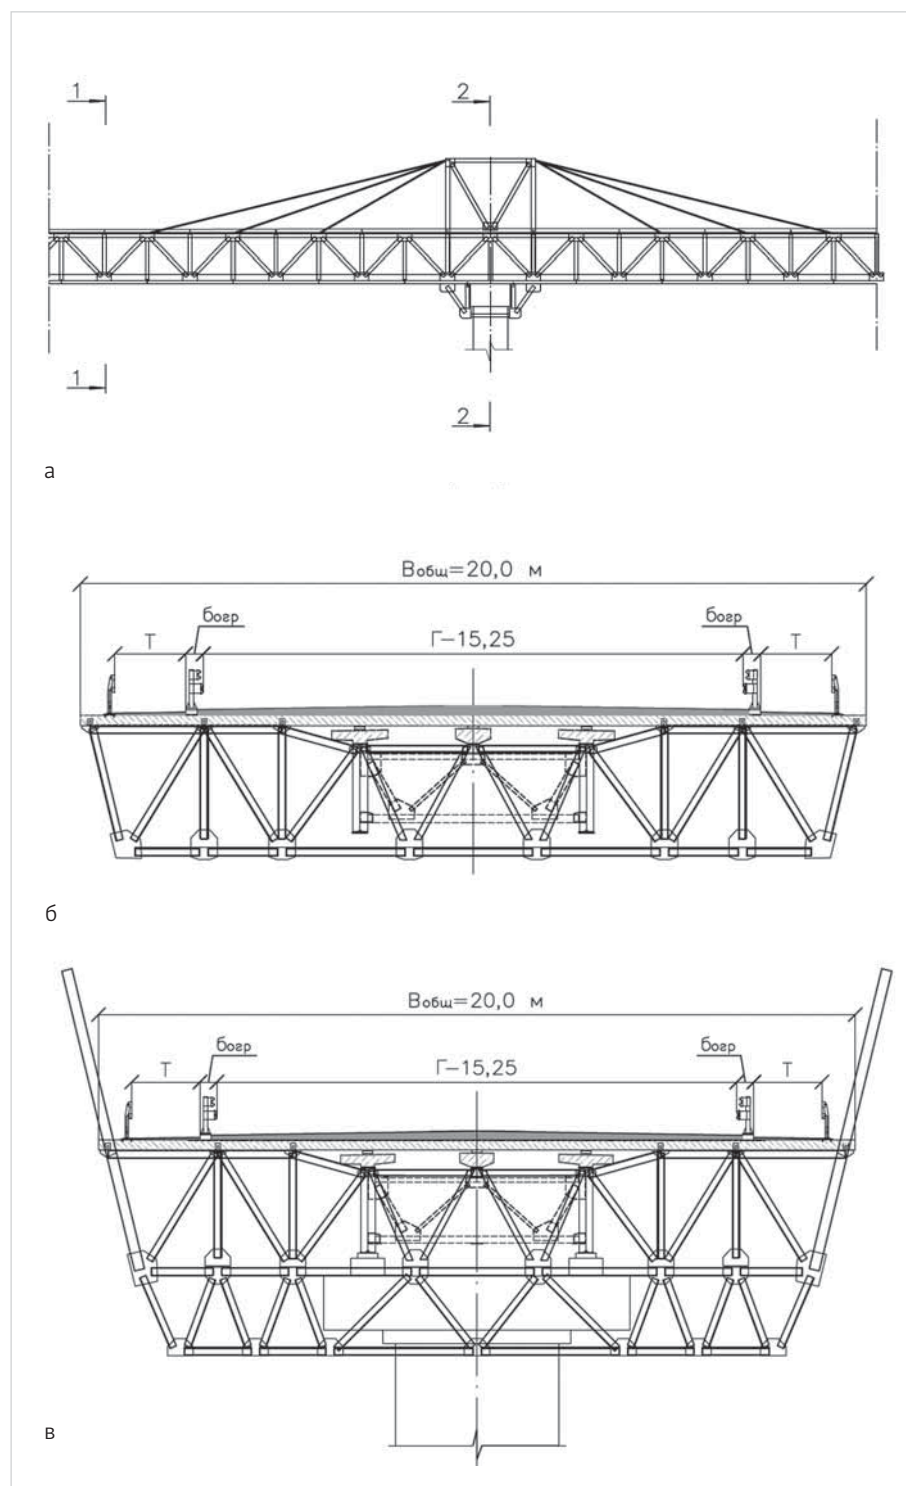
Реконструкция сталежелезобетонного пролетного строения:
